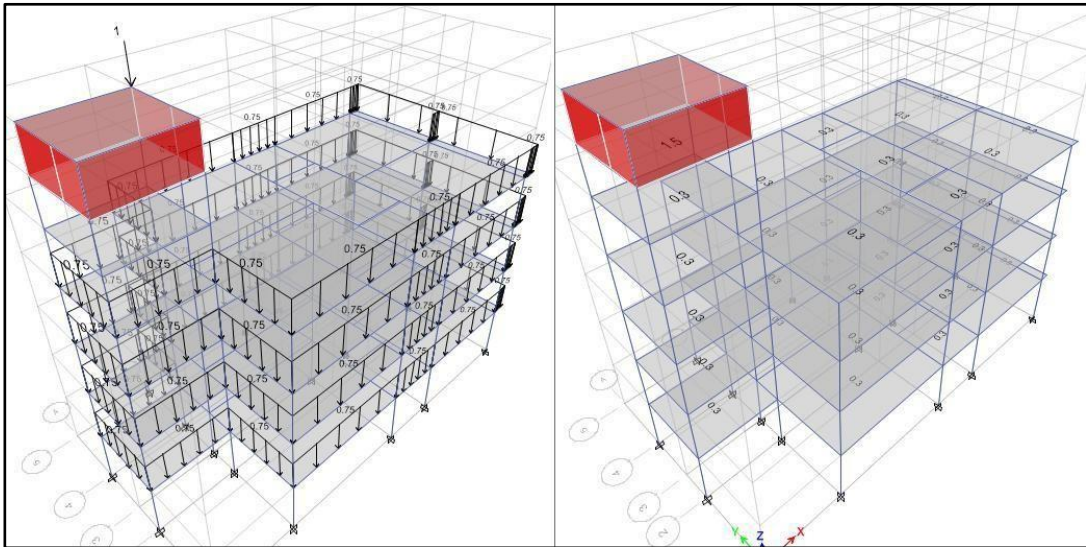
Cargas muertas aplicadas sobre losas y vigas (Tn/m²)
